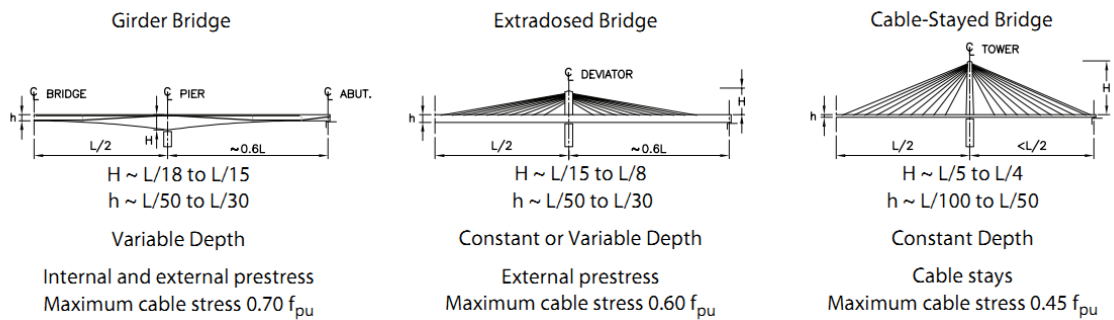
Comparación entre puentes de viga cajón construidos por voladizos sucesivos, puentes de pretensado extradosado y puentes extradosados (Mermigas, 2008)⁵
